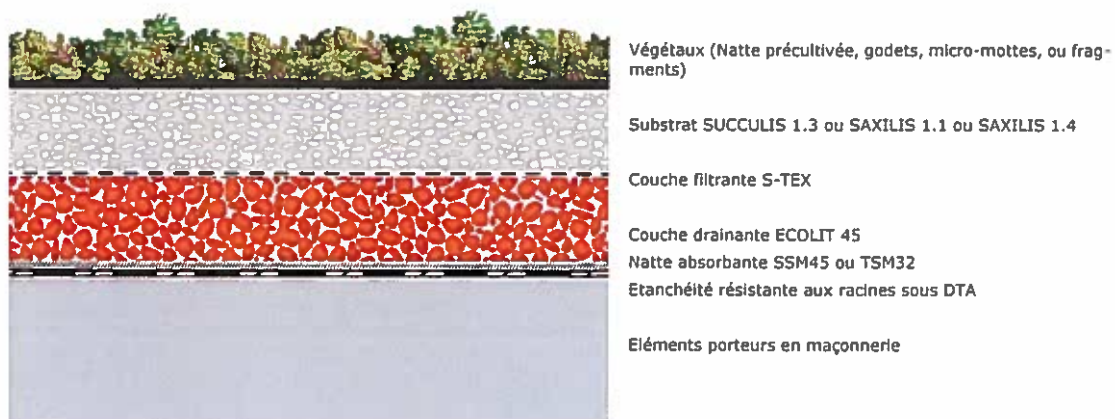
Principe des systèmes de végétalisation ECOVEGETAL sur étanchéité avec couche drainante ECOLIT 6/25 pente < 3%
